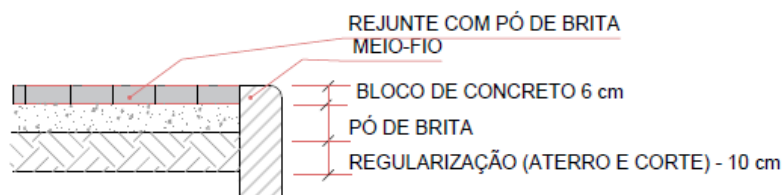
Corte Transversal – Bloco Intertravado 6 cm
